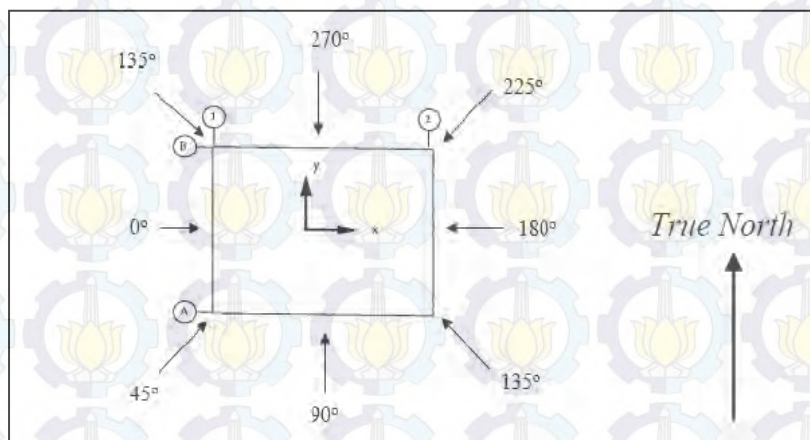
Layout Main Deck (Sumber: PT. Paramuda Jaya, 2012)
